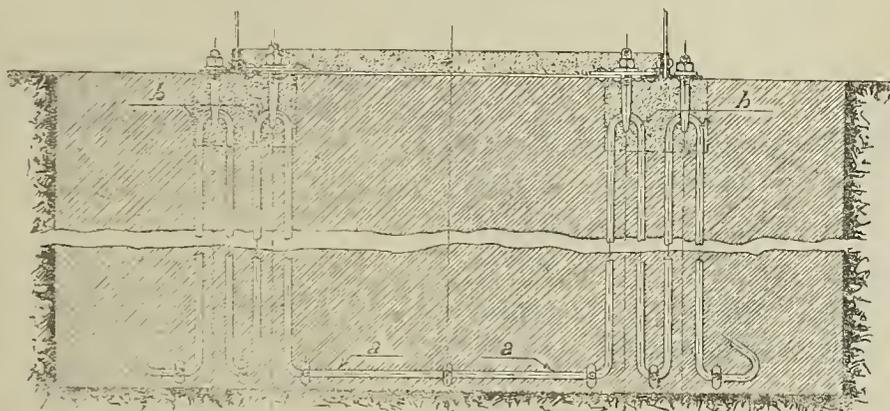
Coupe transversale de la fondation d'un poteau spécial.
